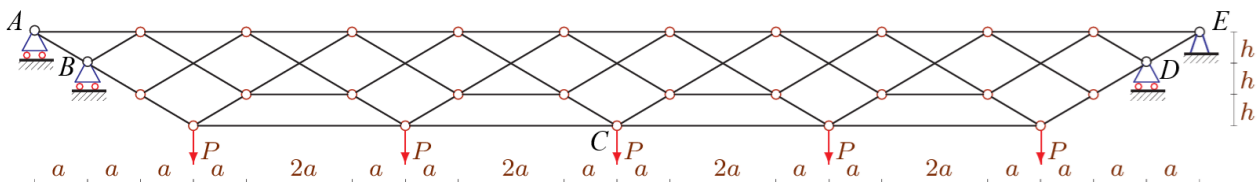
Схема фермы, $n = 2$. Нагрузка на нижний пояс.
